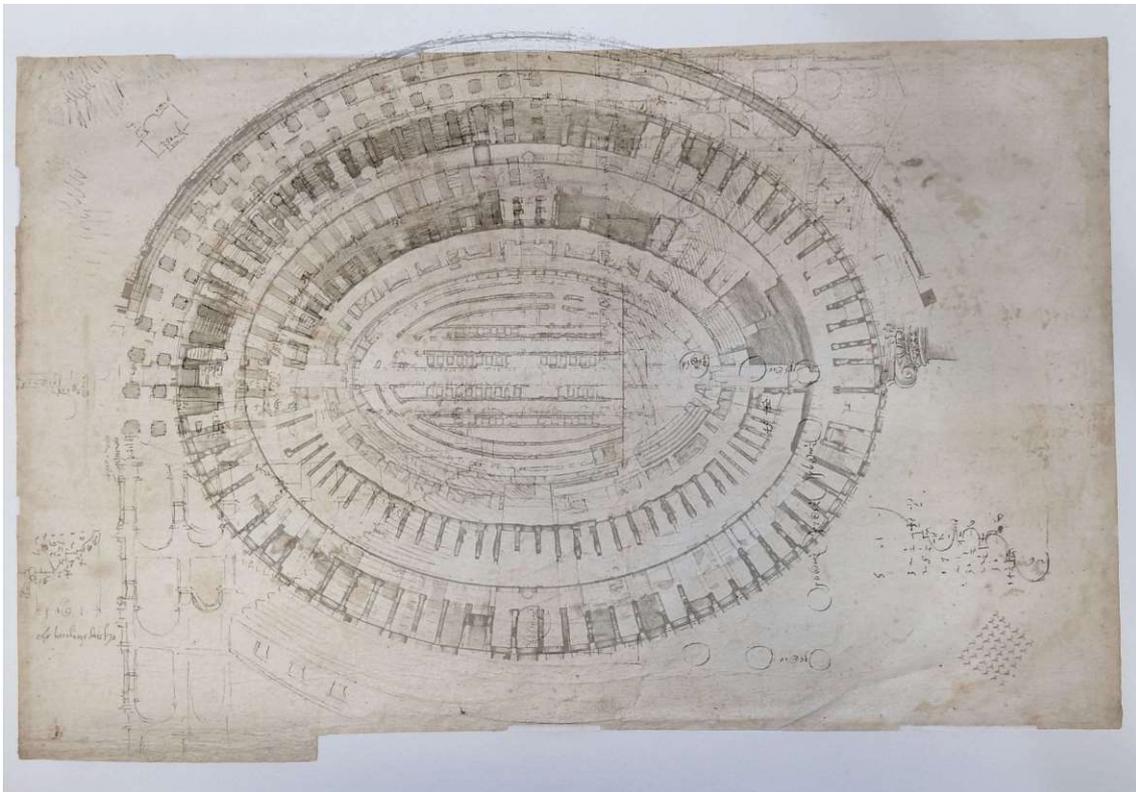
Überlagerung von Andrea Palladios Konstruktionsweise und dem tatsächlichen Grundriss des Kolosseums
